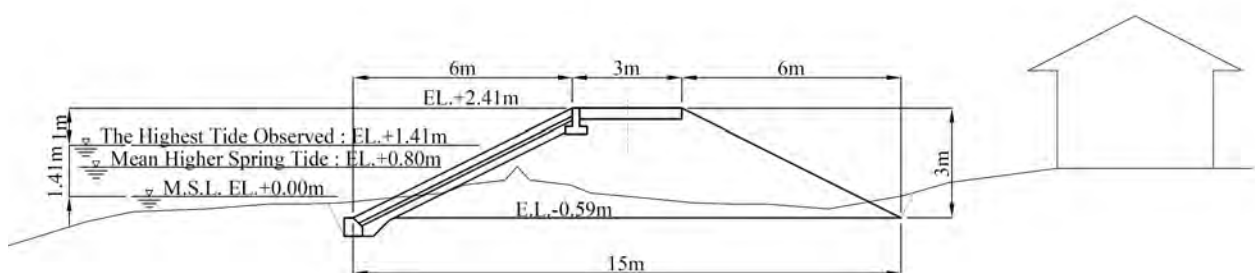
海岸堤 Type C (盛土堤防) 標準断面図
